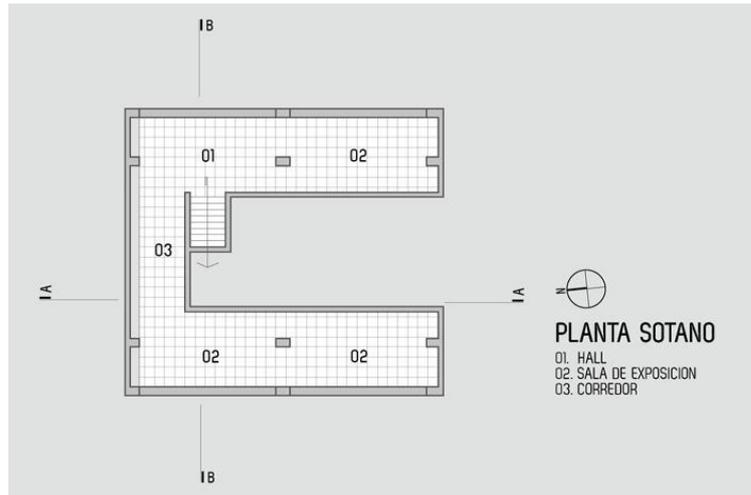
Planta del sótano. Fuente: Archdaily, 2010. Elaboración: Imagen de Porta Guerrero, Paul (2010). Blog de Arquitectura Moderna.
